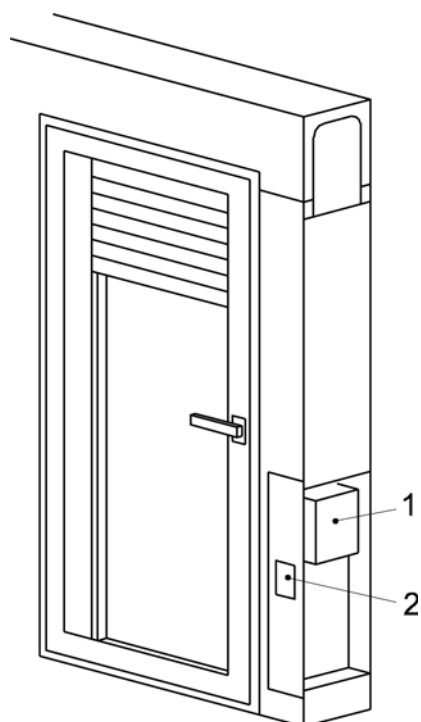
Sezione verticale - Sistema di ventilazione meccanica controllata integrato nel cassonetto
